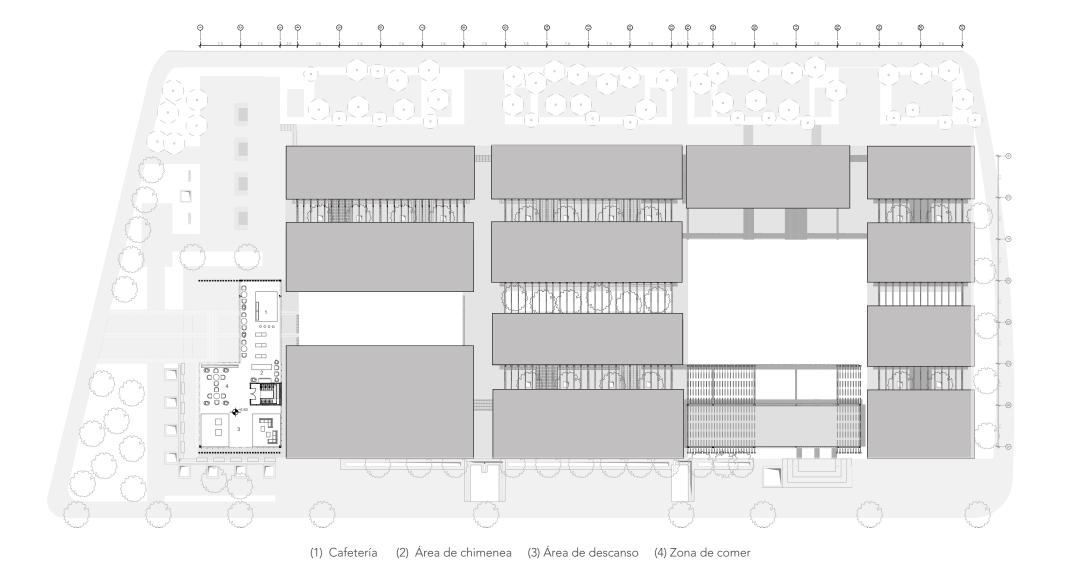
3era planta general Fuente: Elaboración propia 2023.
